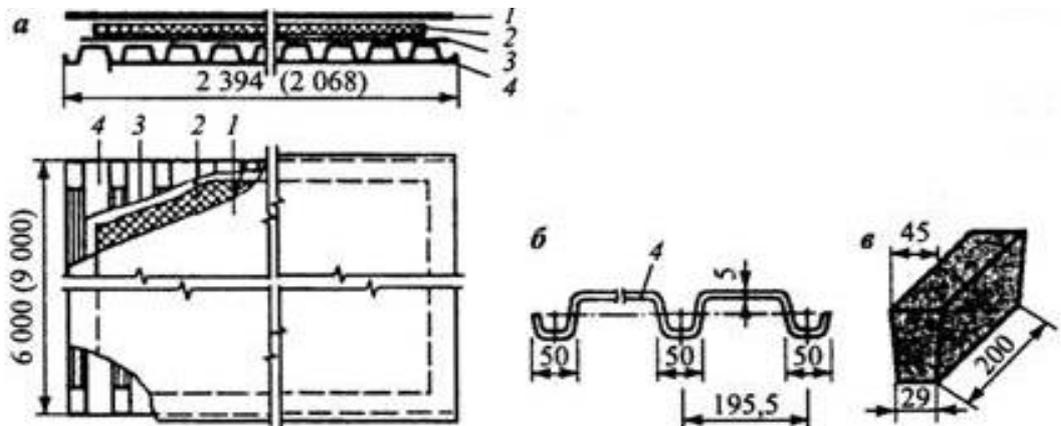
Панель покрытия из оцинкованных стальных профилей: а - панель покрытия; б - оцинкованные профили; в - бетонный вкладыш, укладываемый в гофры по краям стального настила; 1 - кровельный ковер; 2 - теплоизоляция; 3 - пароизоляция; 4 - профилированный настил
